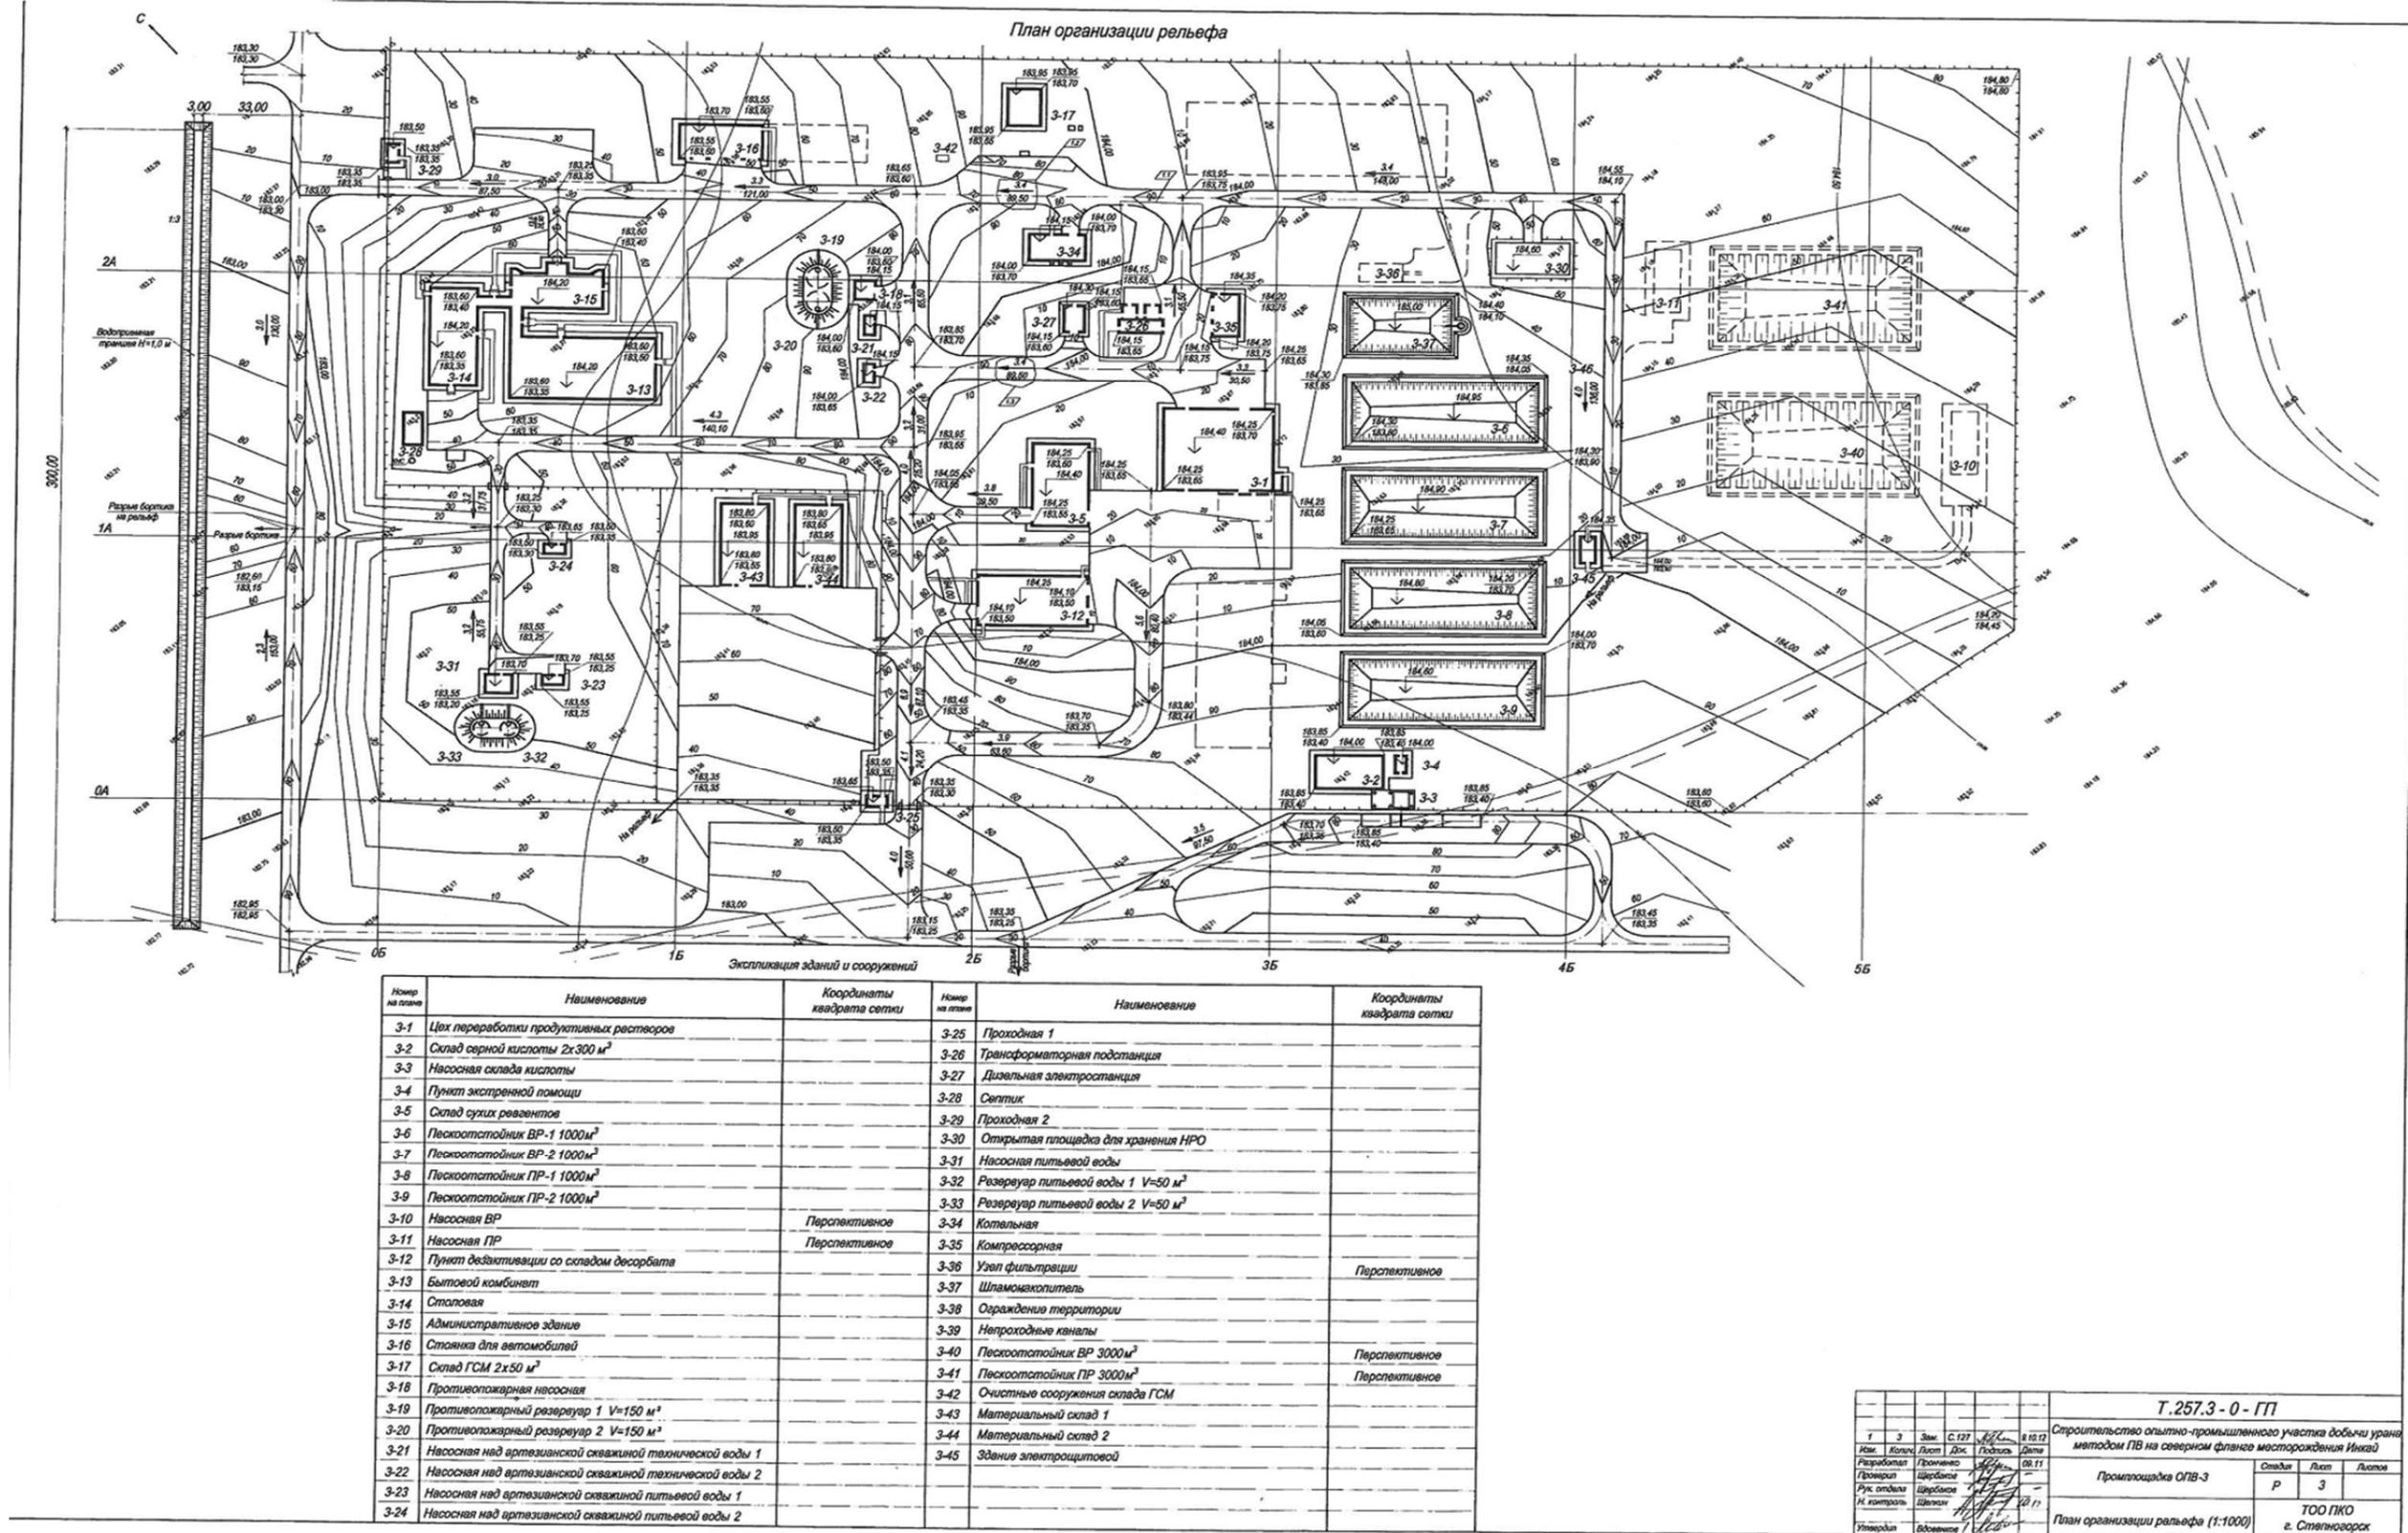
План расположения зданий и сооружений промплощадки Сателлит-2
